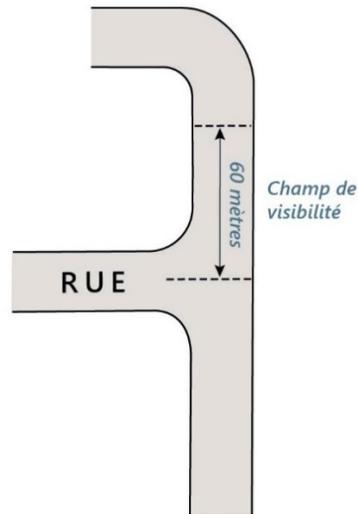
Intersection sur une rue de 18 mètres d'emprise
